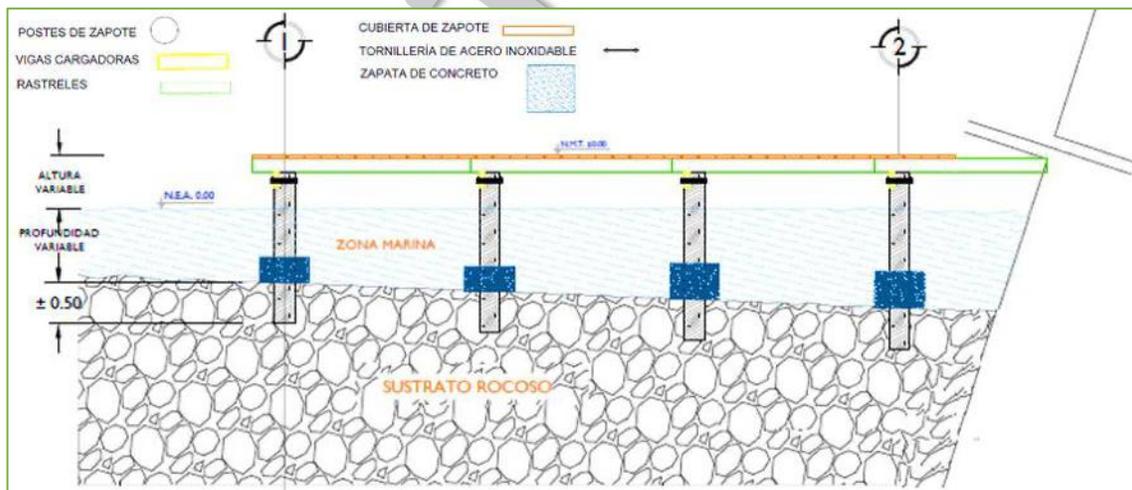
Indica el modelo base constructivo para el muelle, en las uniones de los tabloncillos de la cubierta y pilotes para soportes.
